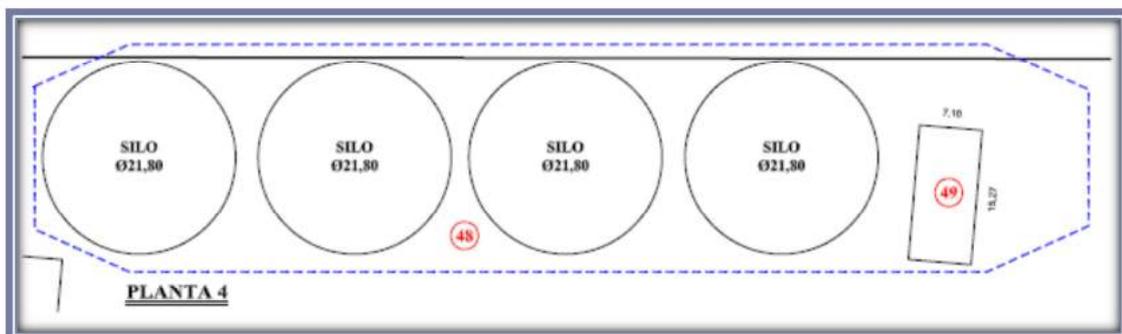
Planta de Silo 4 (Ref. n° 48) y Caseta de descarga (Ref. n° 49)
